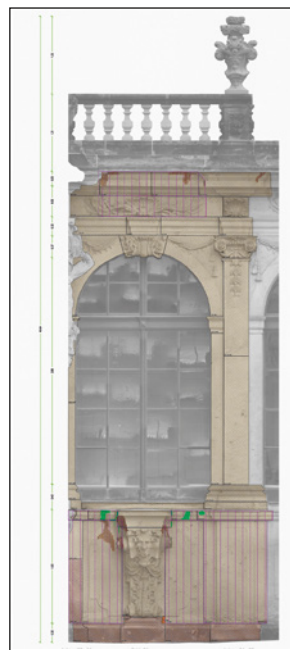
Orthofoto eines Fassadenabschnitts aus dem Dresdner Zwinger mit Kartierung des Gesteinsbestandes und der geplanten Maßnahmen
